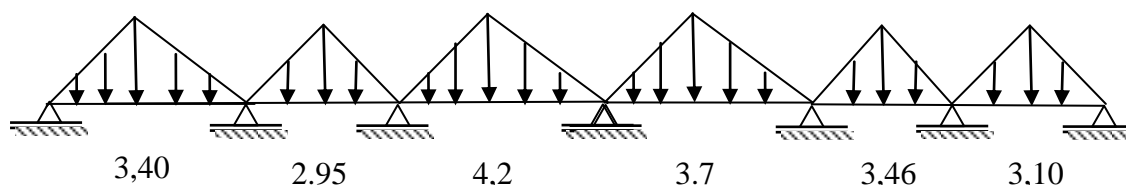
Distribution des charges sur les poutres secondaires
